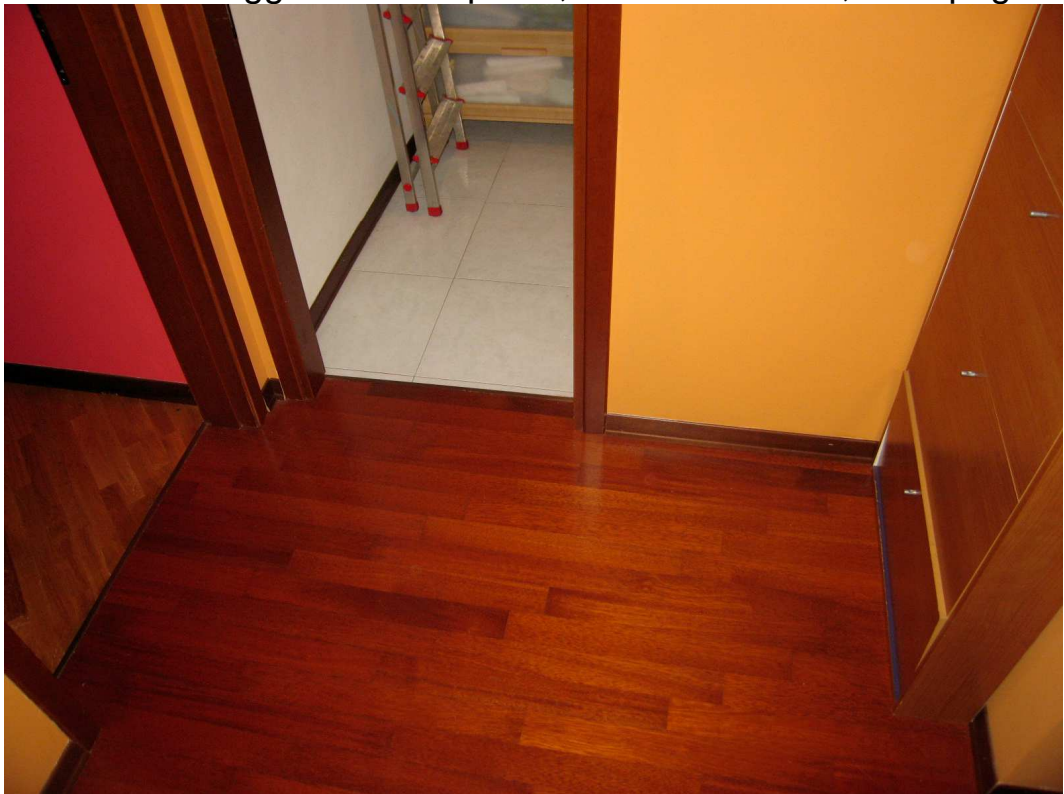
Alloggio al terzo piano, subalterno "10", ripostiglio
